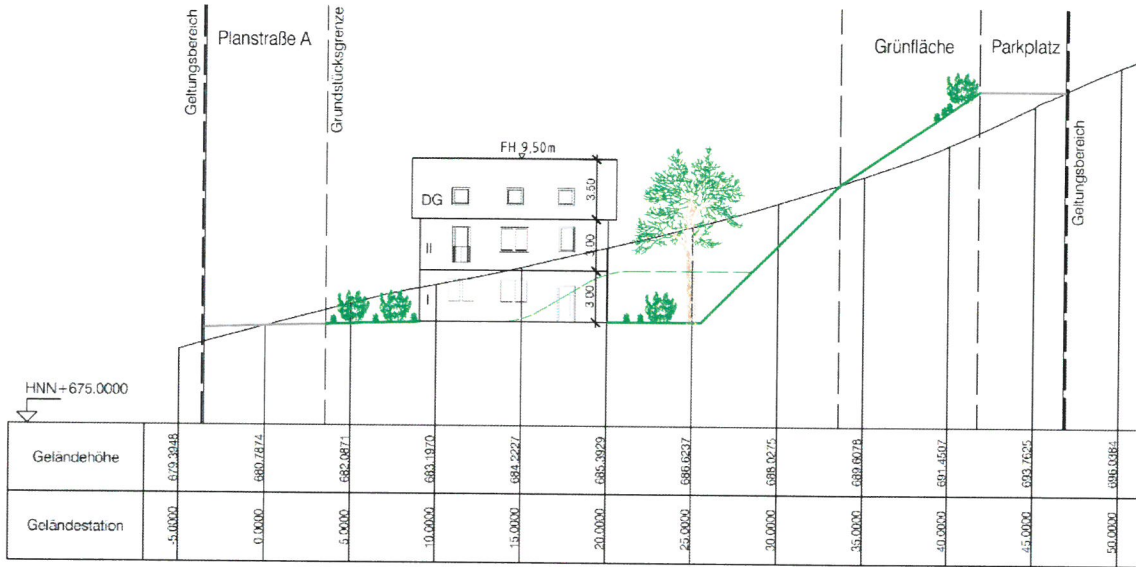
Geländeschnitt 1 (Bebauung modellhaft)
